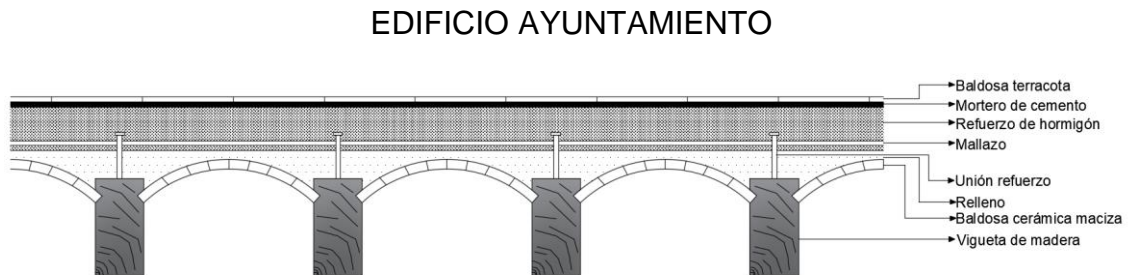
Detalle forjado. Fuente: elaboración propia, creación 06/07/2019
